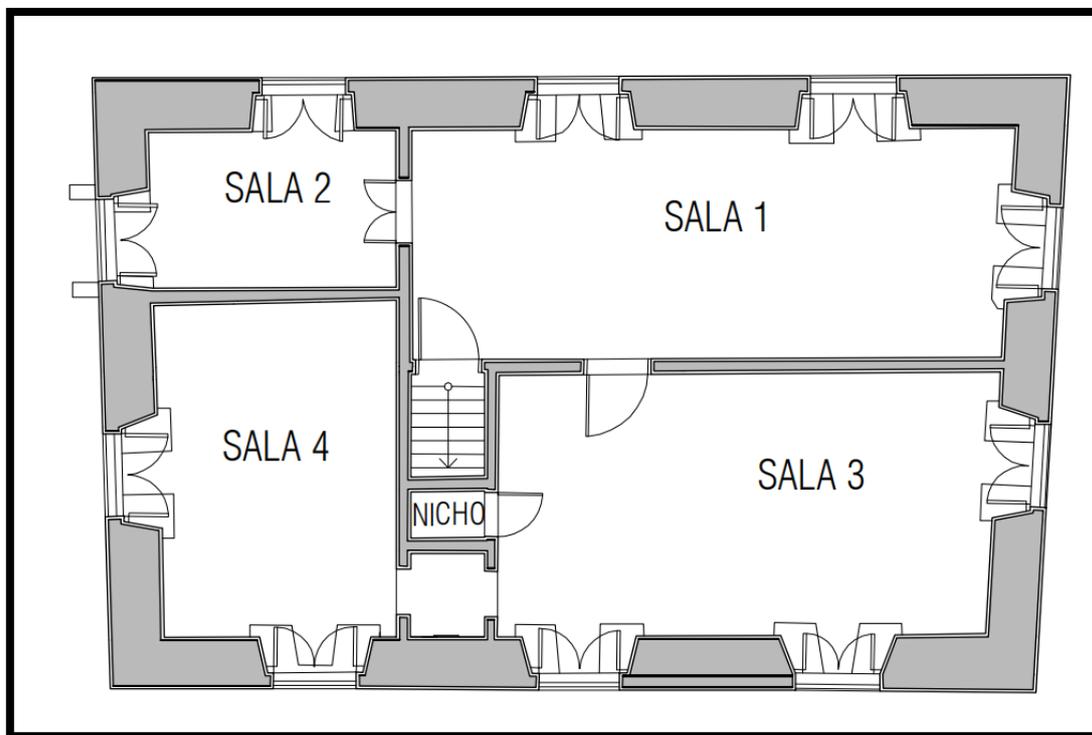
Planta baixa - pavimento superior – sem escala (Fonte: produção da autora)
